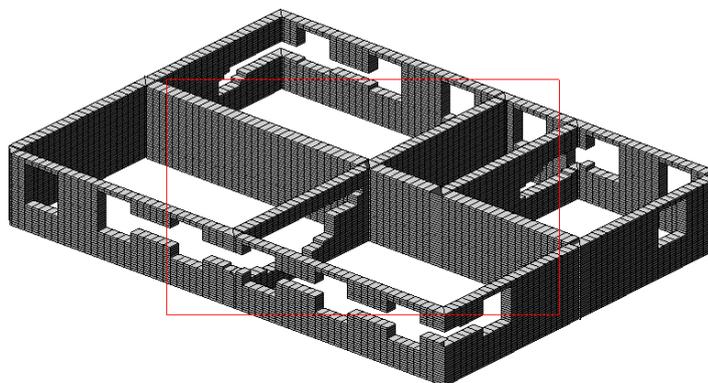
Схема этажа с разрушенными кирпичными стенами
